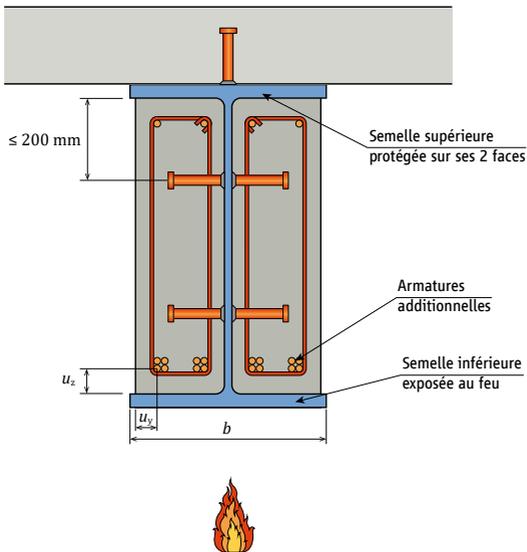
Protection au feu d'une poutre avec enrobage partiel
